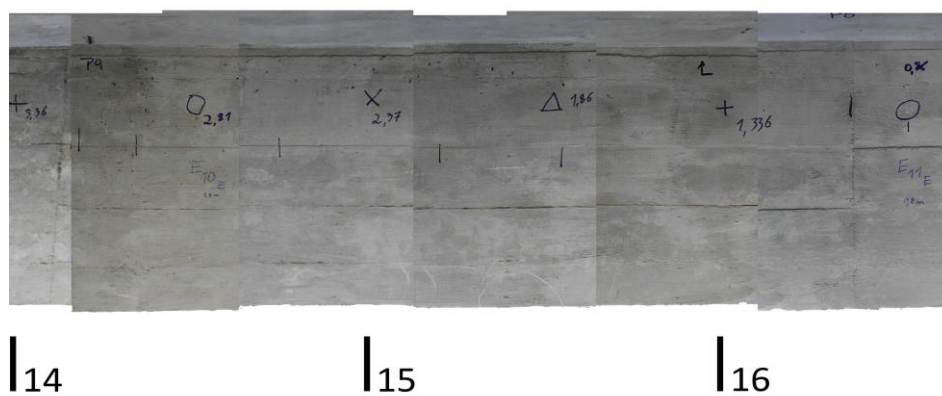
Foto da viga esquerda entre os 14 e 16,5 metros
